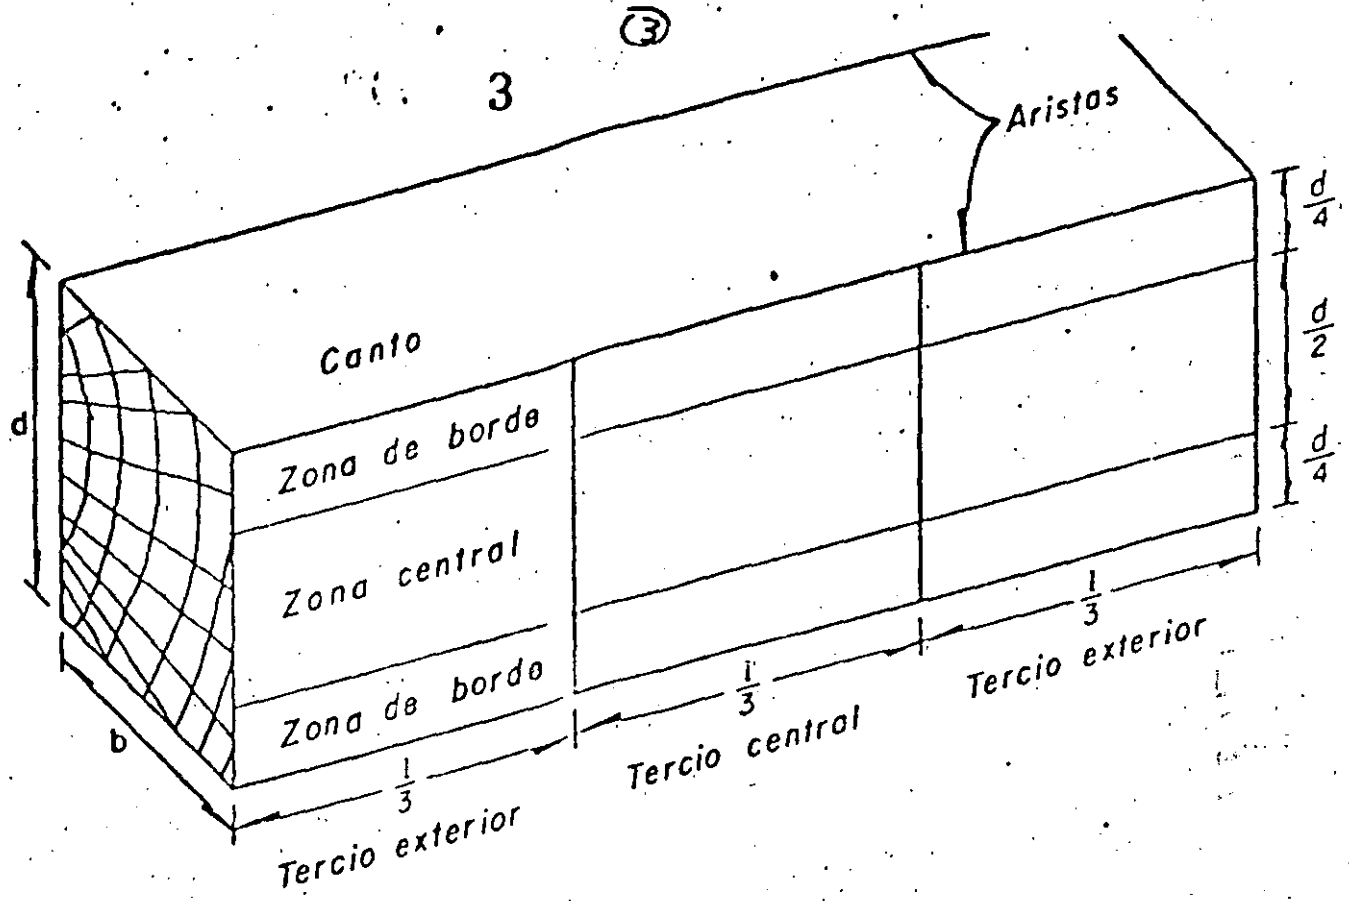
Fig I. Zonas en un elemento a flexión, para su clasificación estructural
